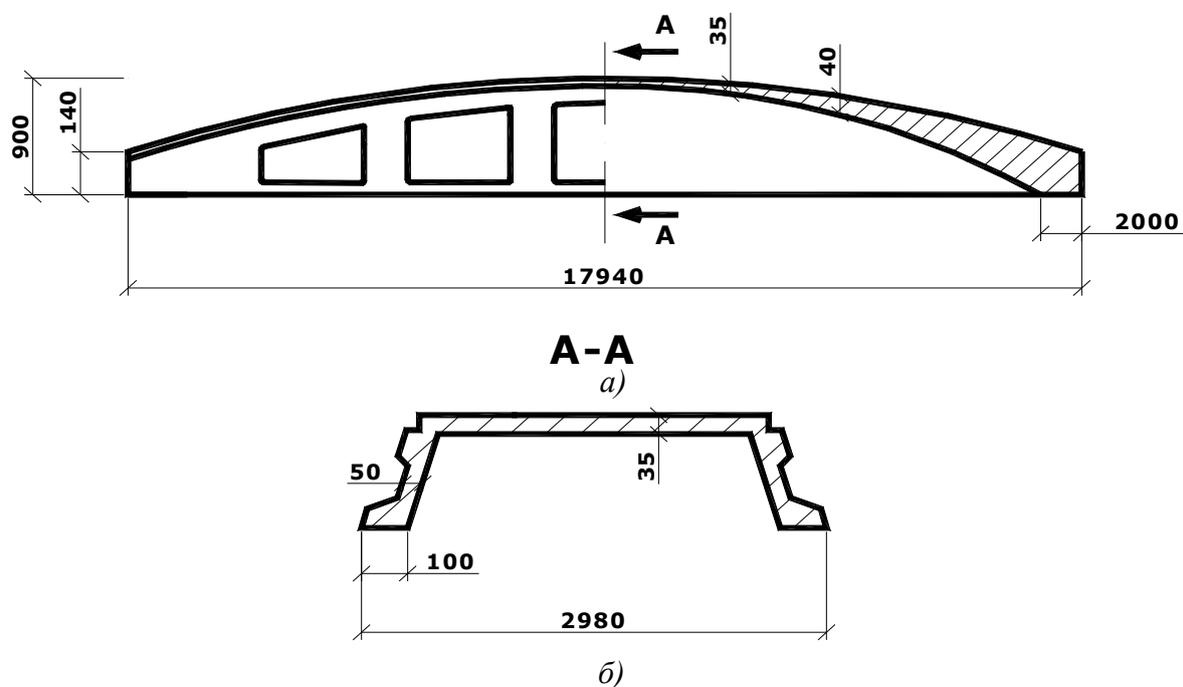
Плита покрытия КЖС: а – общий вид; б – поперечное сечение
